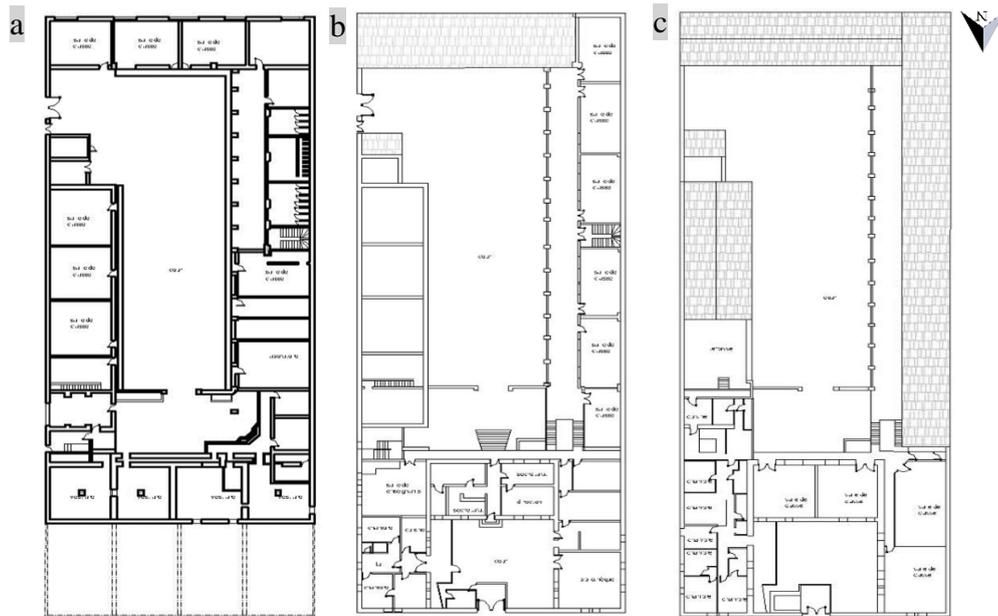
Le relevé architectural du collège. (a) plan de l'entresol ; (b) plan du RDC ; (c) plan du R+1 (auteure, 2023)
